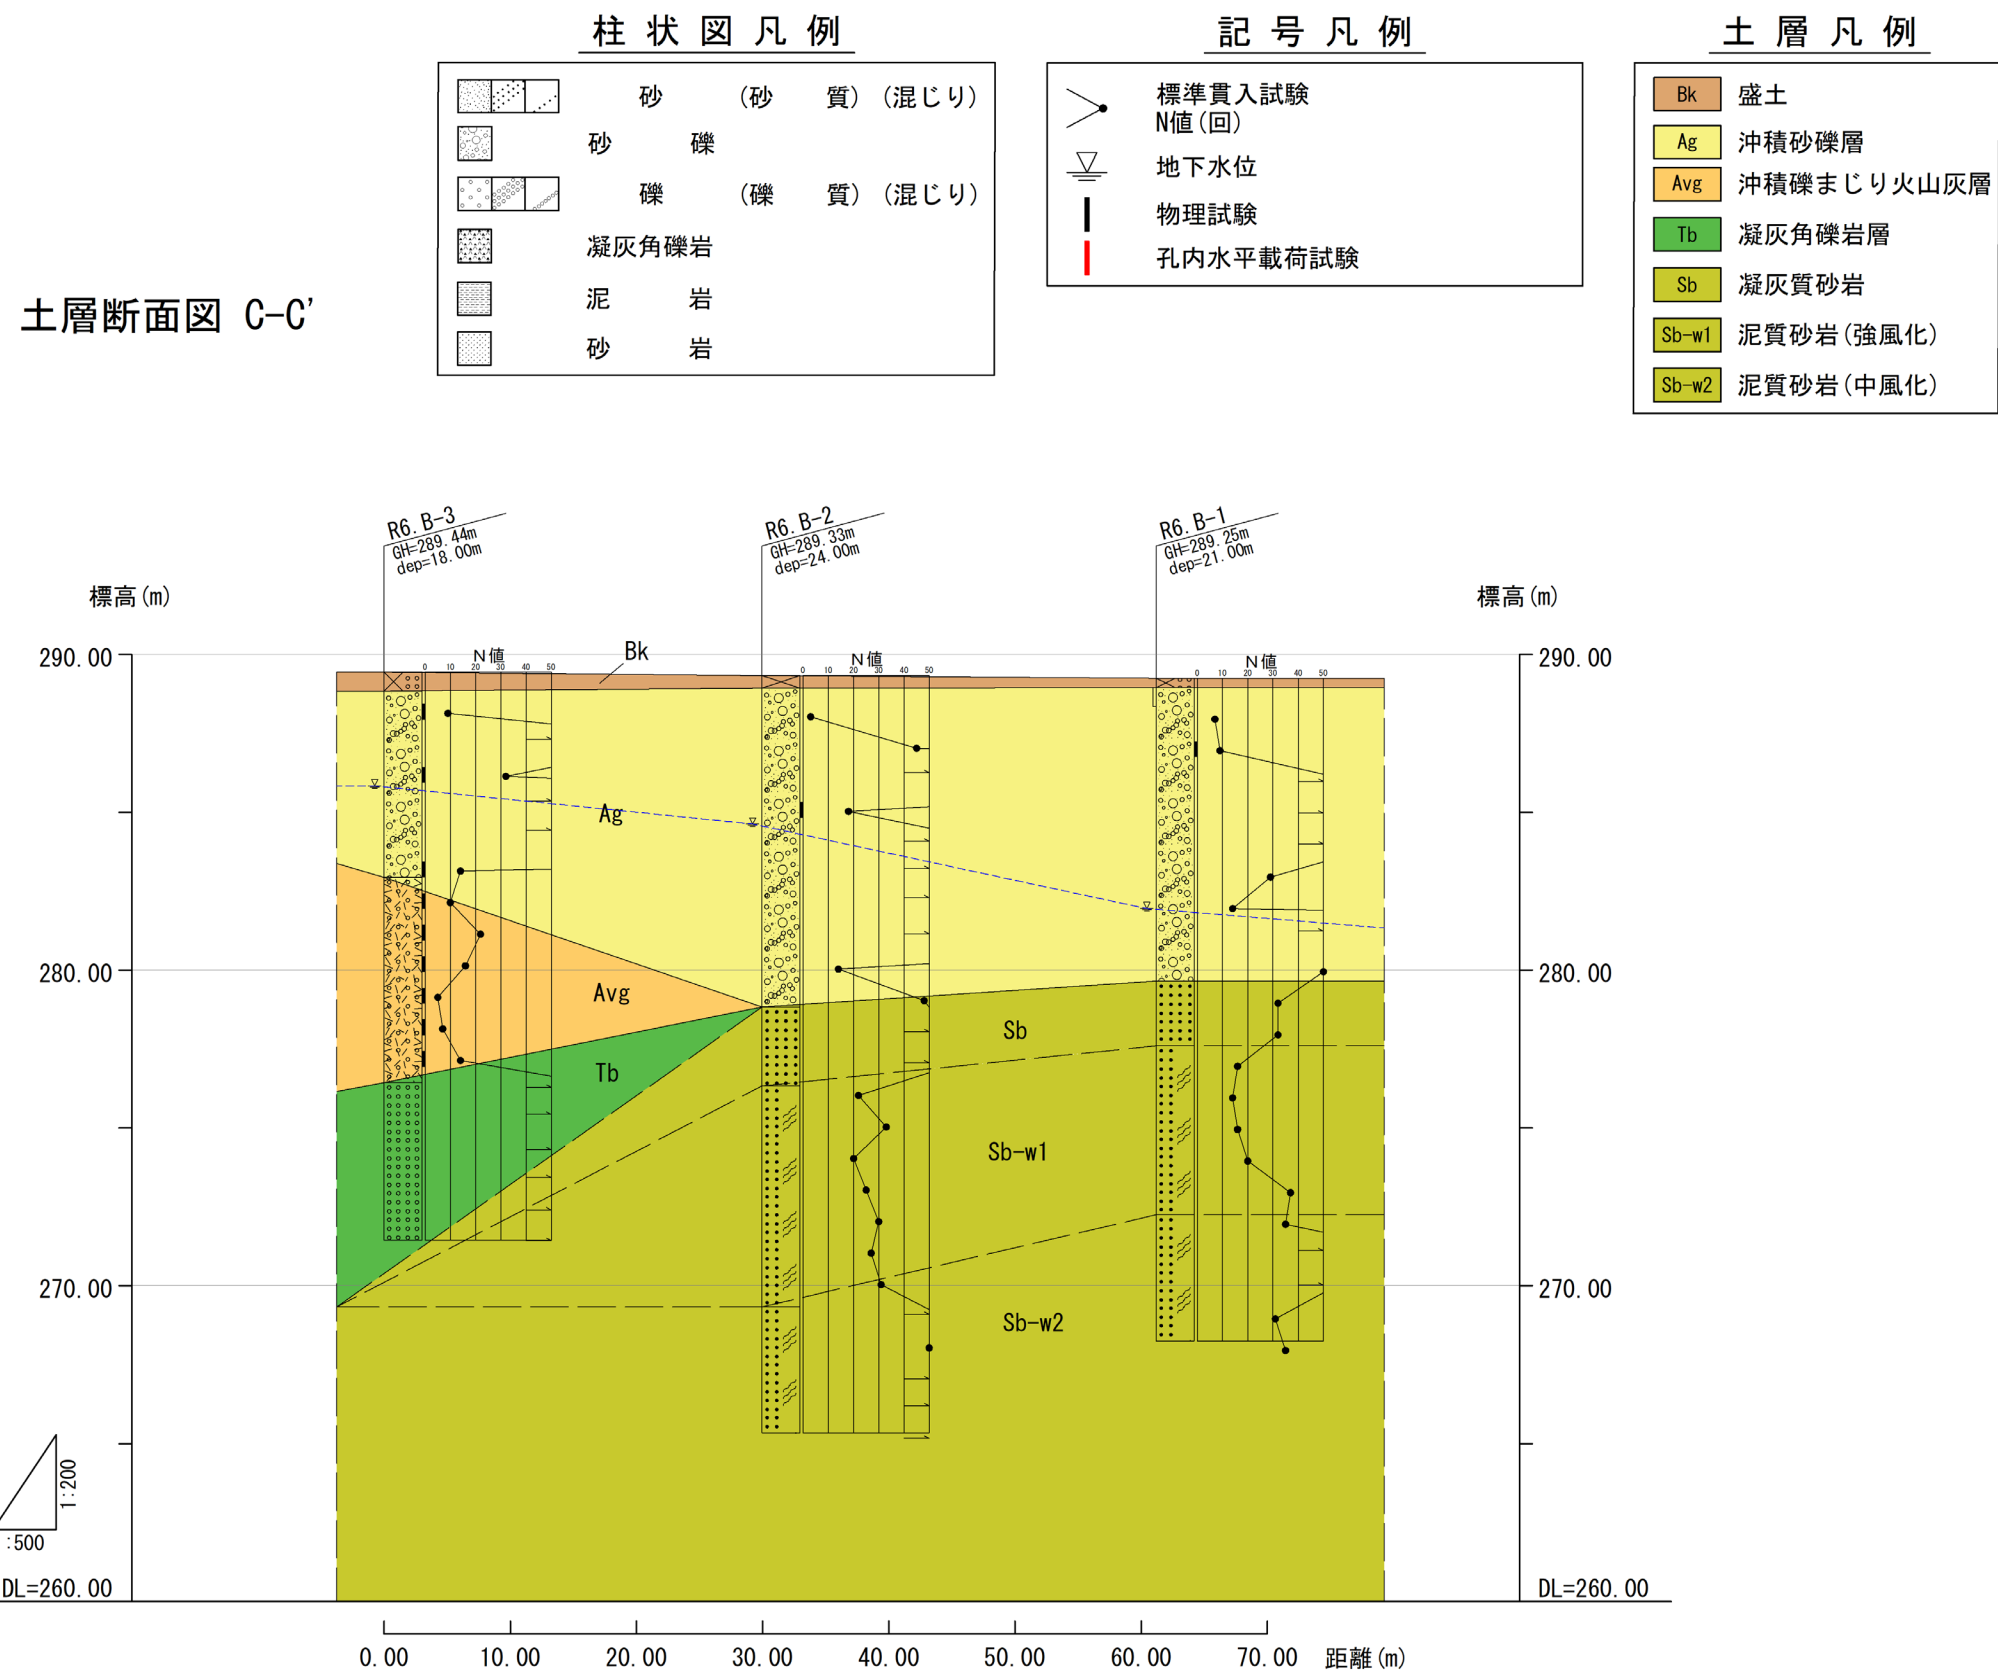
土層断面図 C-C' (SH=1:500 SV=1:200)
